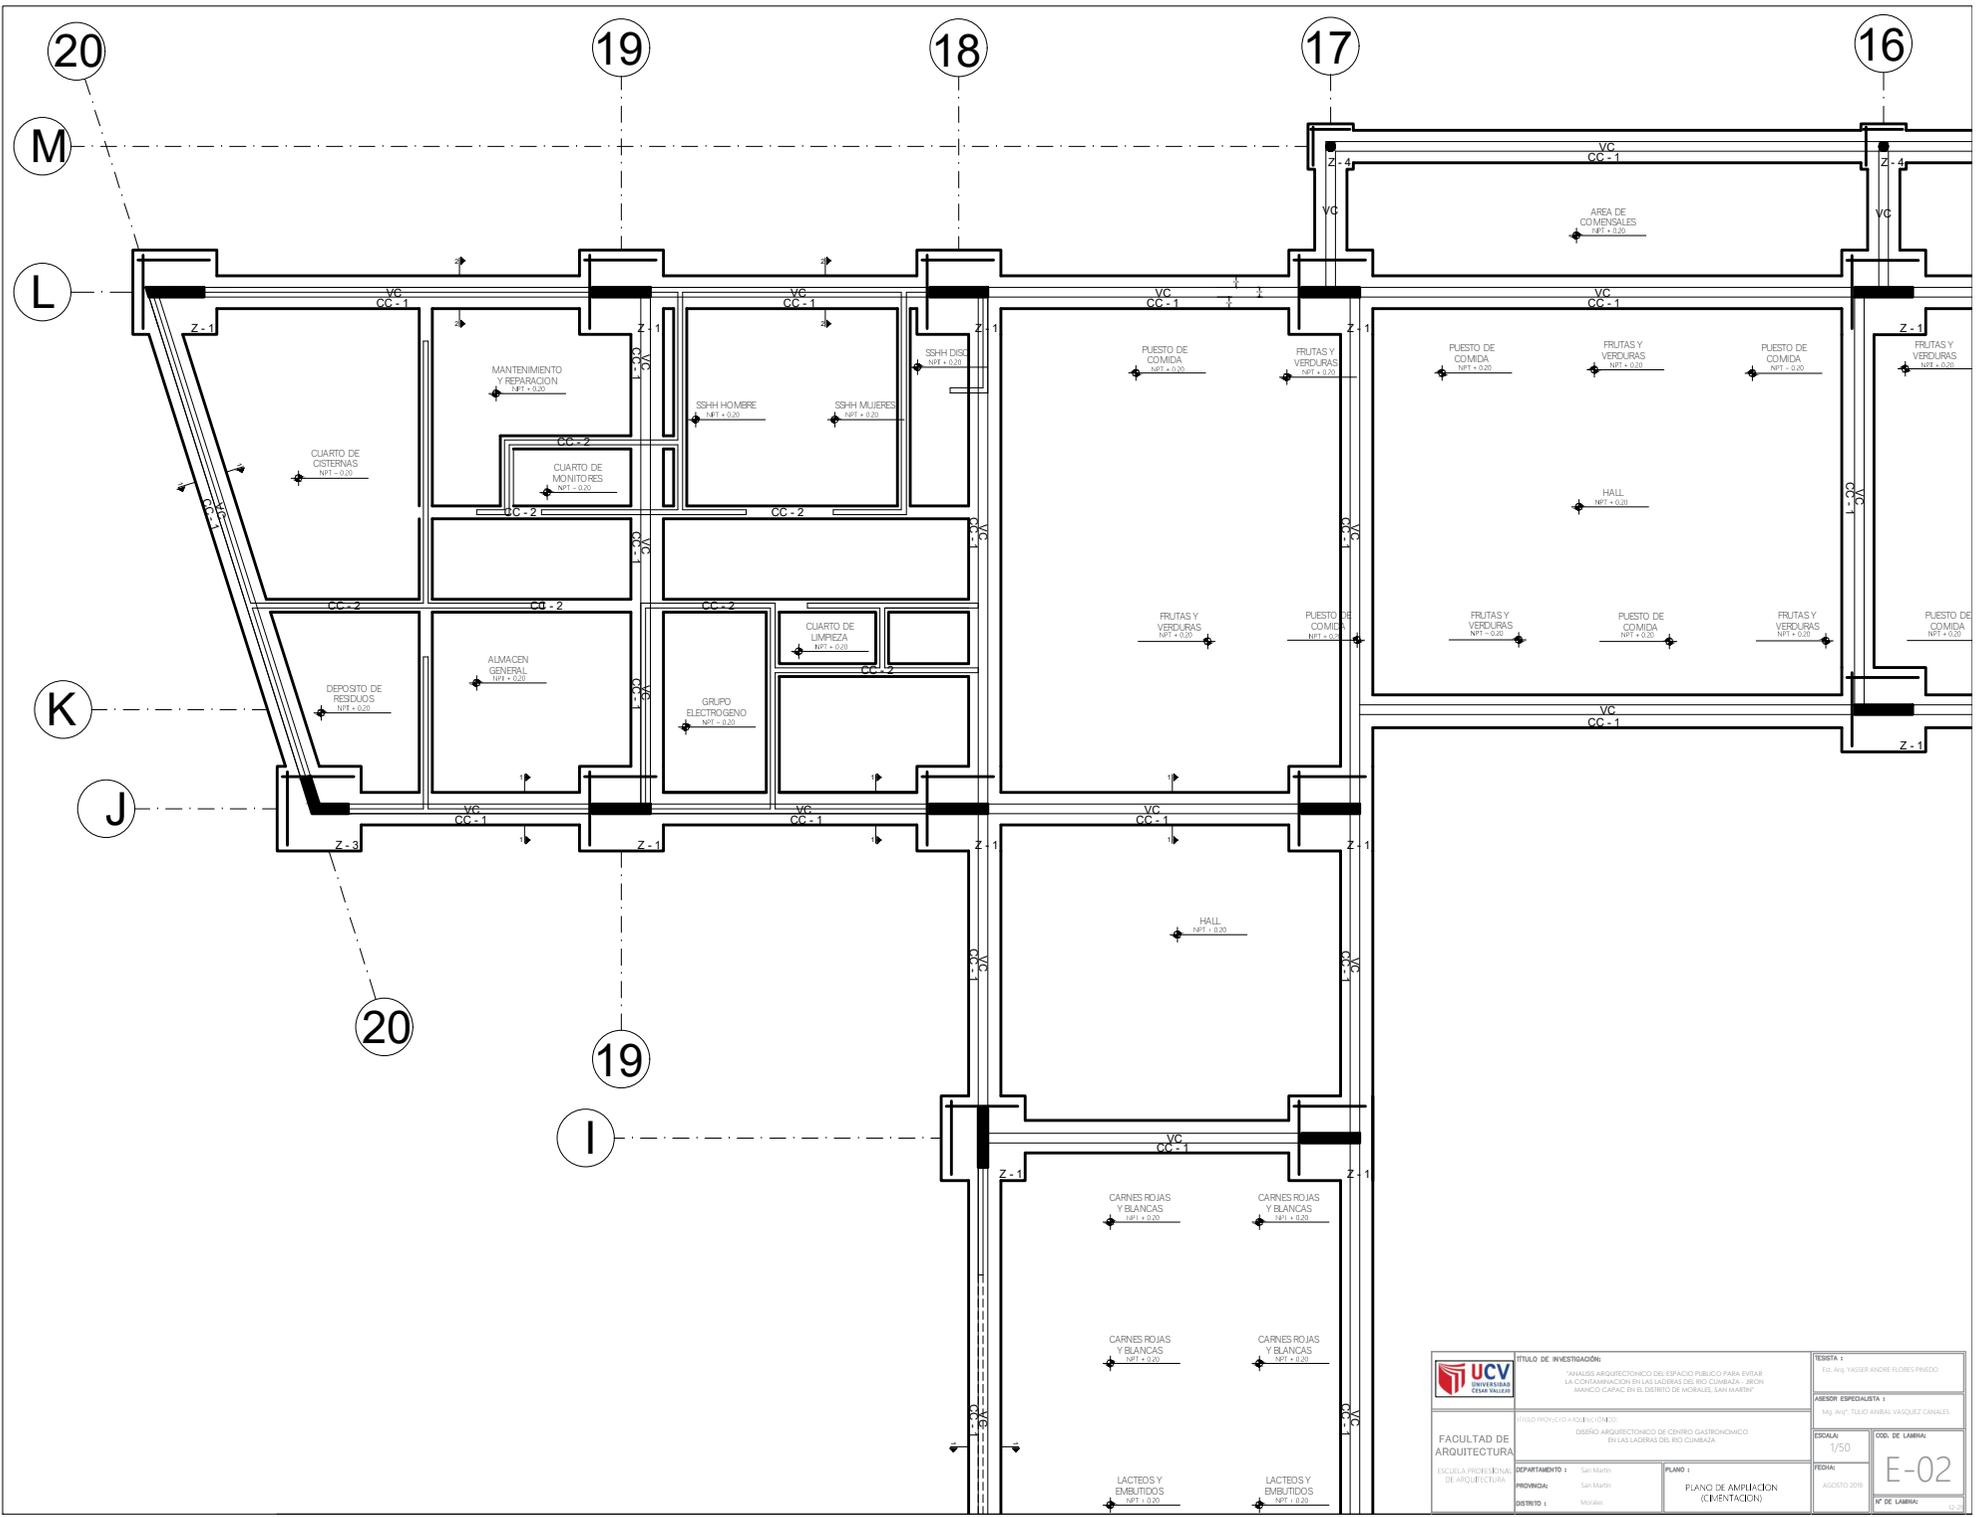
Planos estructurales - cimentación (ampliación)
